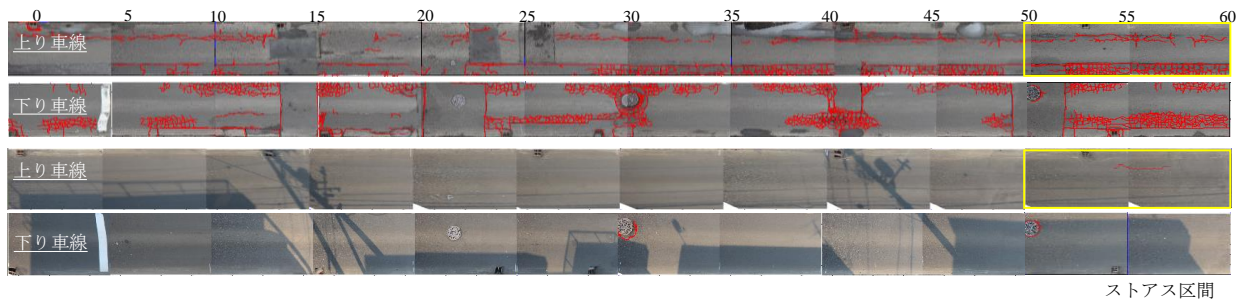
ひび割れ状況図（上：施工前、下：供用1年後）※赤線はひび割れ箇所
